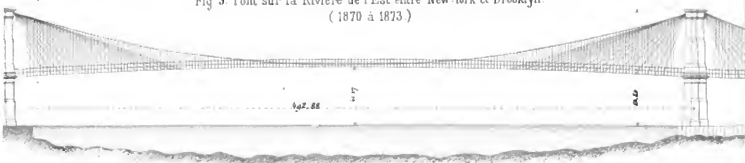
Pont sur la Rivière de l'Est entre New-York et Brooklyn.
